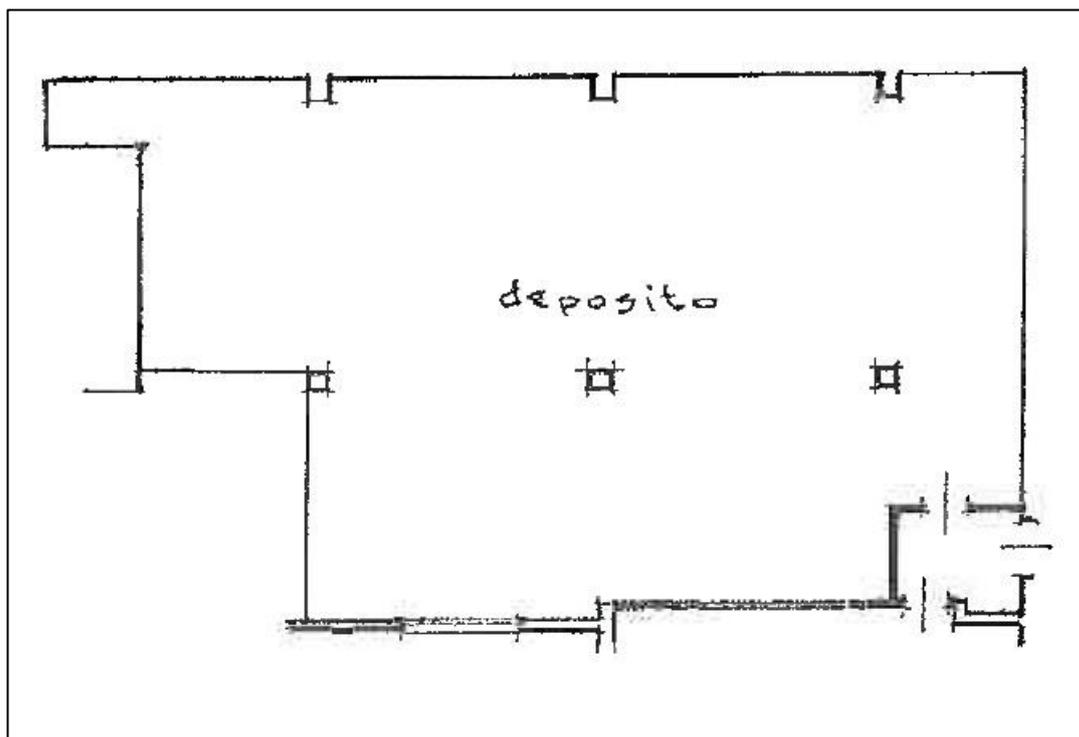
planimetria del piano S1 (sub 48) adibito a magazzino
